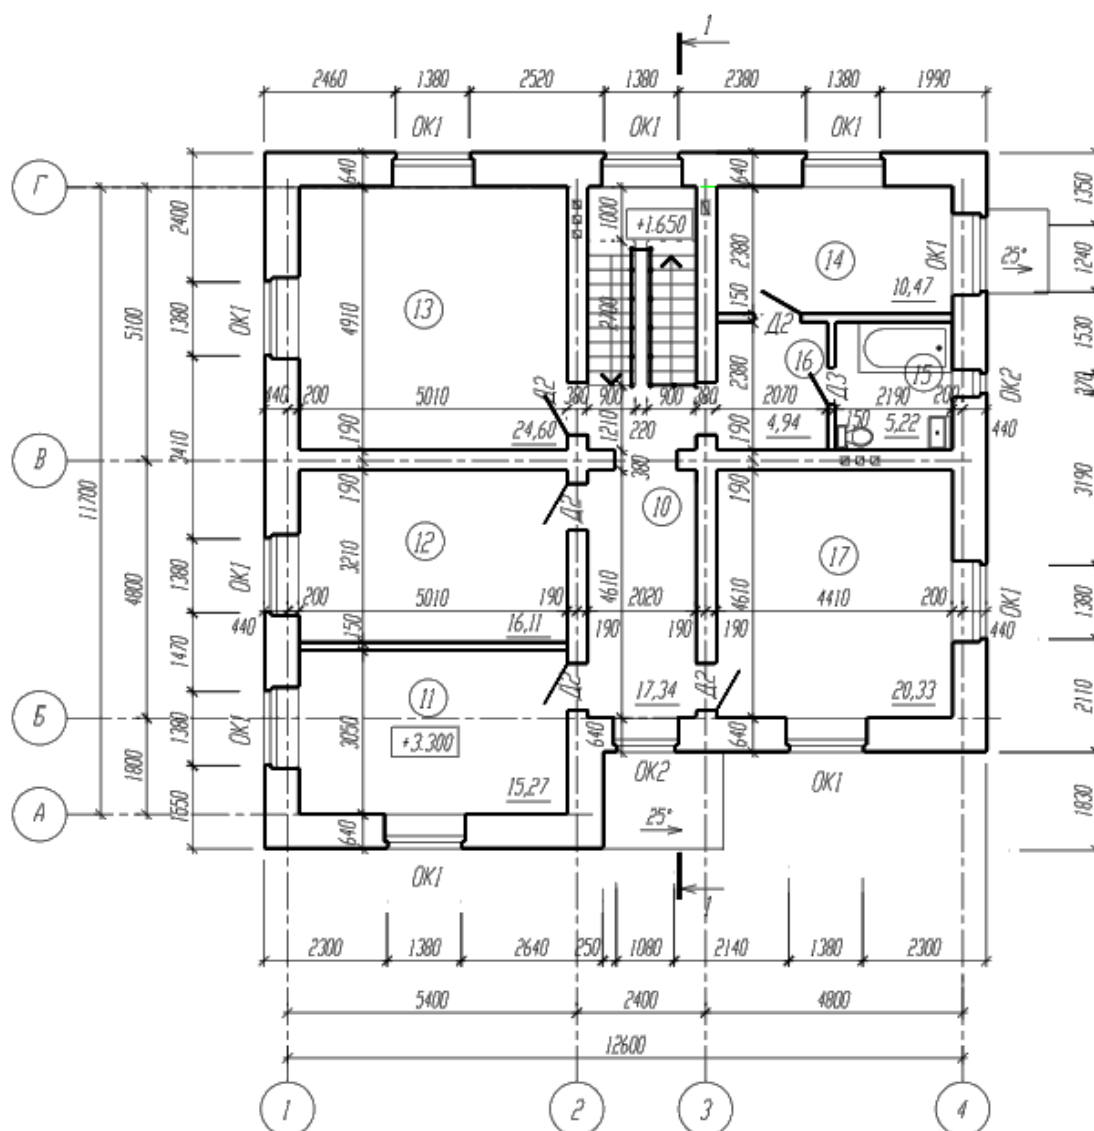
Пример оформления плана 2-го этажа жилого дома, со стенами из мелкоштучных материалов.
